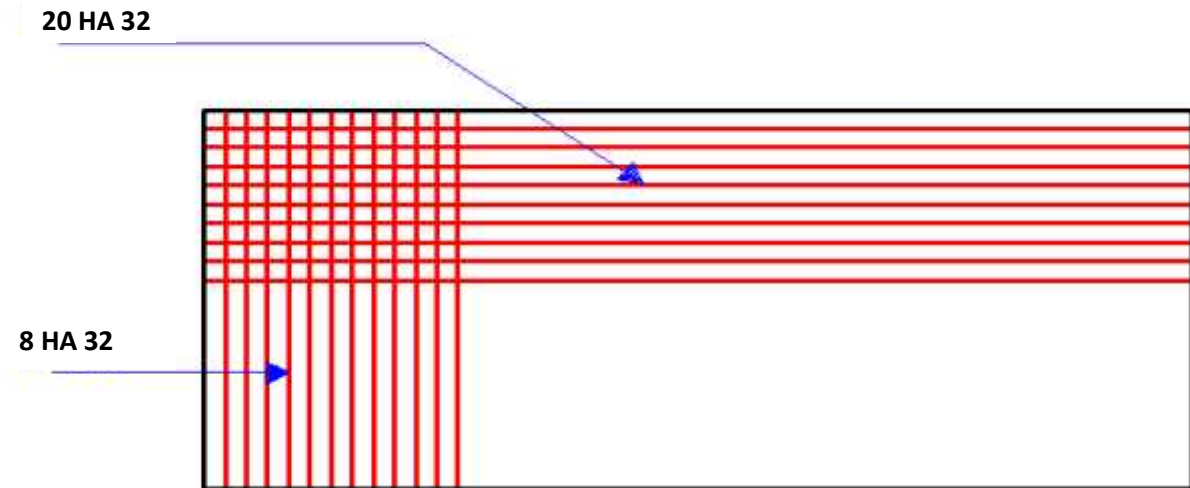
Schéma de ferrailage (nappe inférieure)
